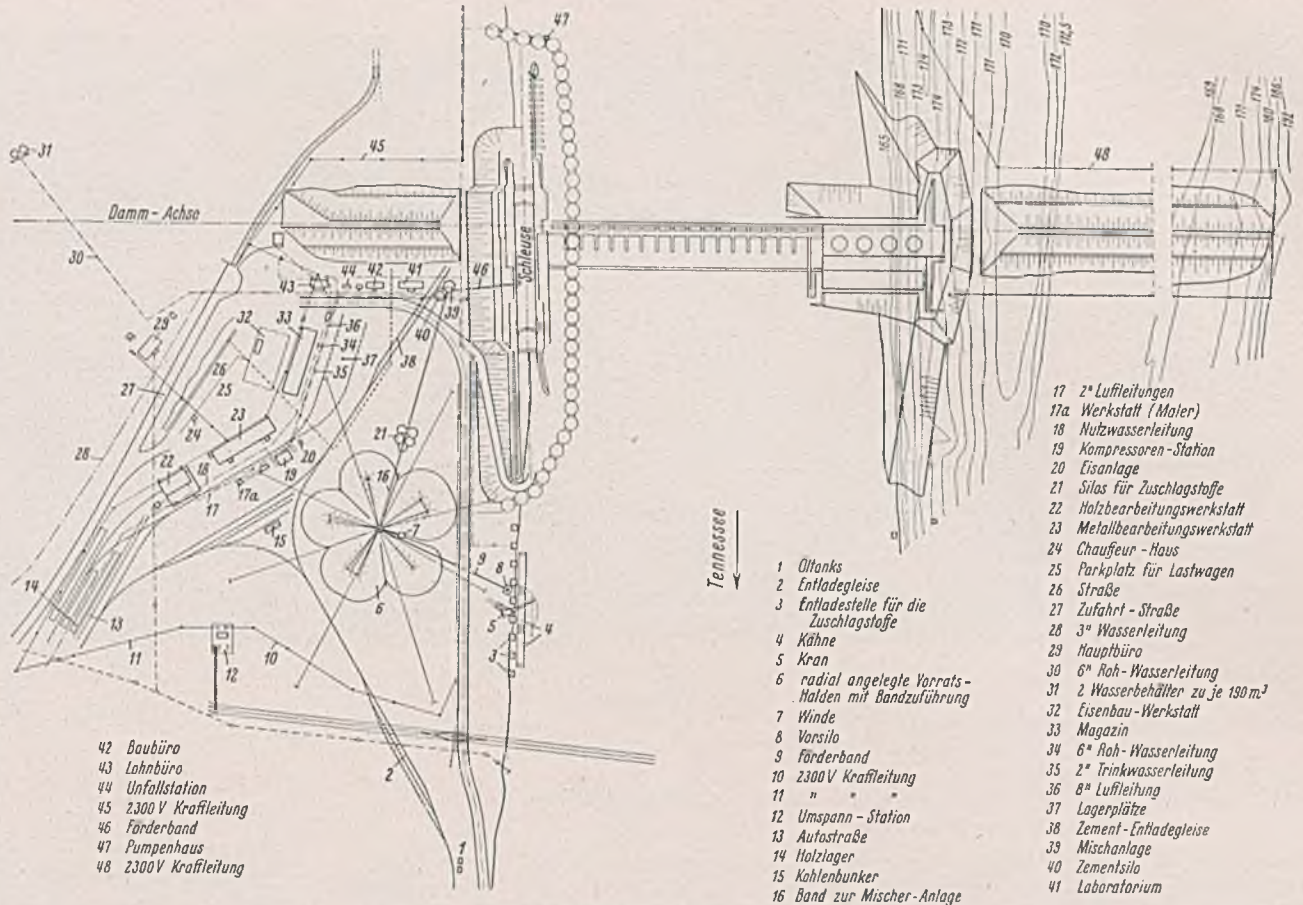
Die Bauanrichtung des Guntersville Dam.
